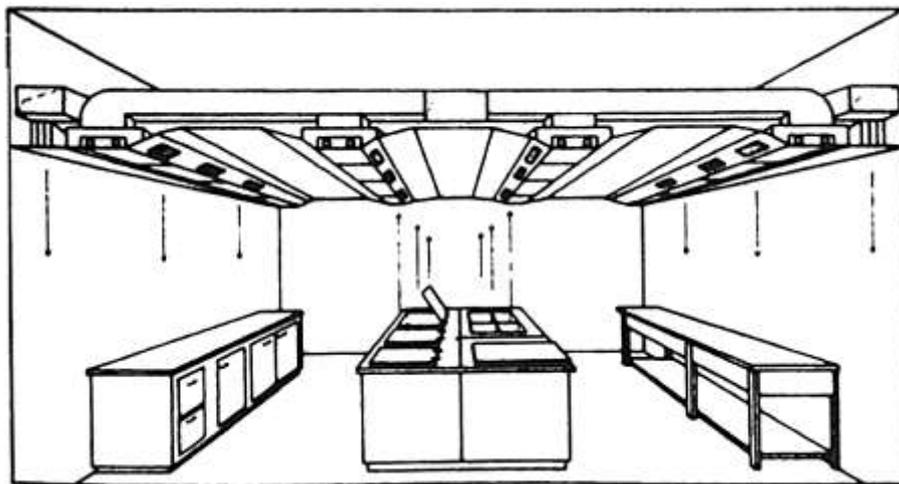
Комплексне розв'язання підвісної вентиляційної стелі з трубопроводами притікально-витікальної вентиляції та електронним освітленням великої кухні (обладнання фірм Wimböck, Reit im Winkel)
